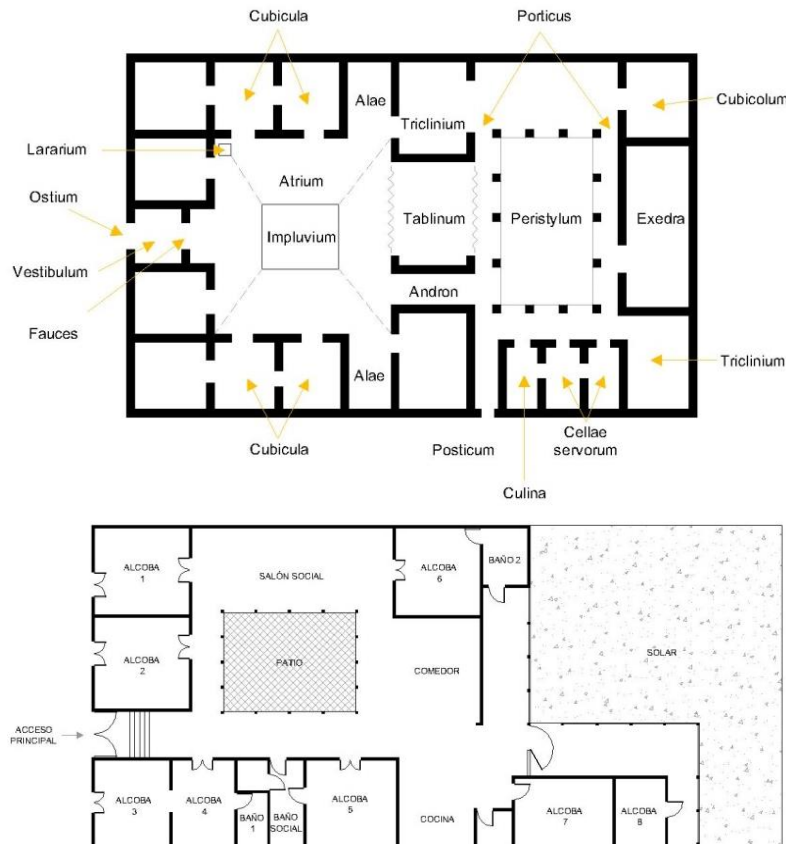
Planta Domus romana. Imagen 320. Planta casa Calle 6 No. 8-34/40, Belén de Umbría, Risaralda.
